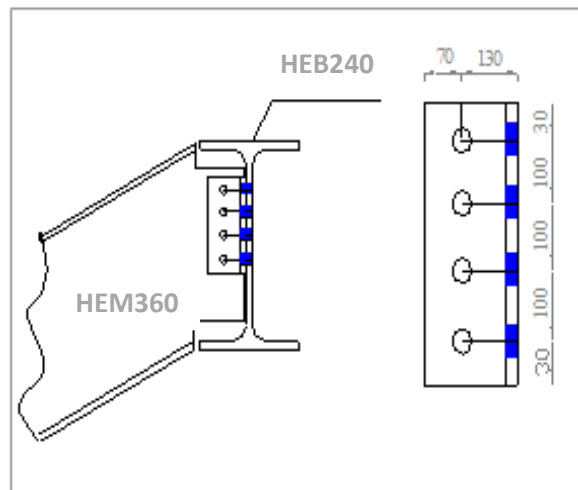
Assemblage poutre-rampe (HEB240- HEM360)
